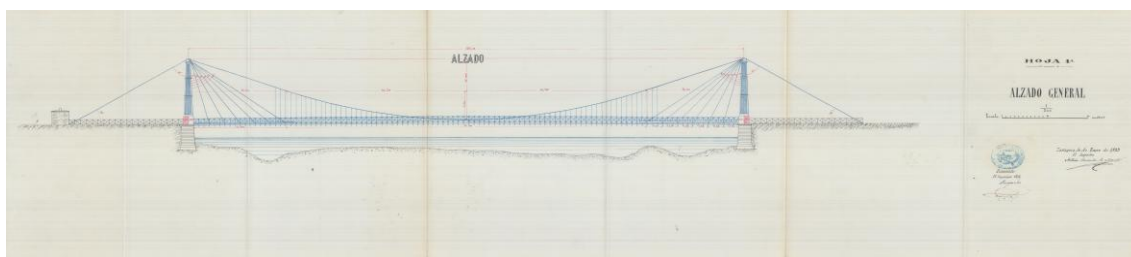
Proyecto de reparación del puente de Santa Isabel. Alzado. Zaragoza, 30 de enero de 1889.
